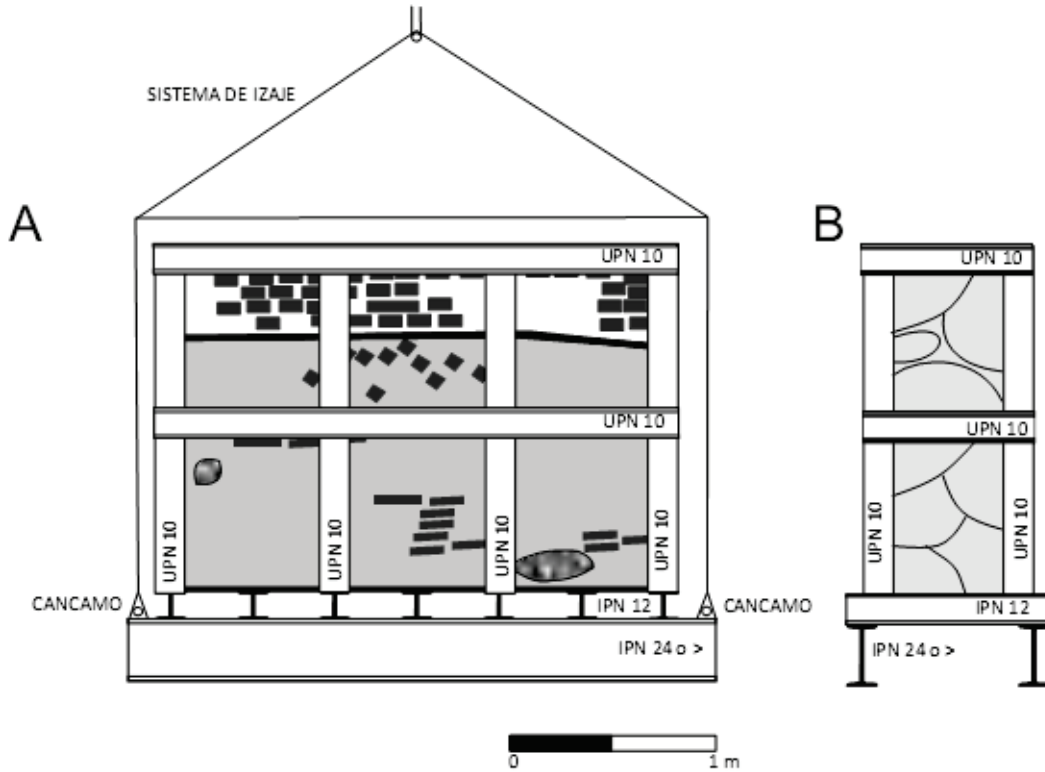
A: Vista de la estructura en caras sur y norte del cimient. B: Corte transversal
